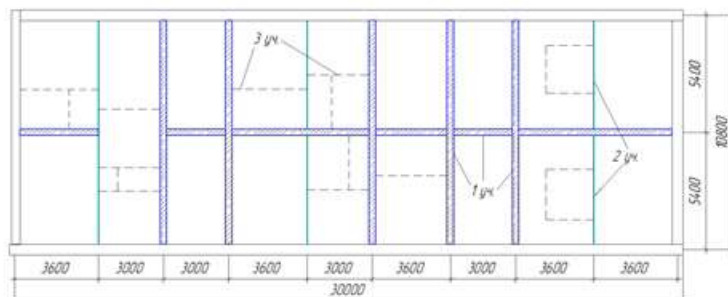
План типового этажа 5-и этажного жилого здания
